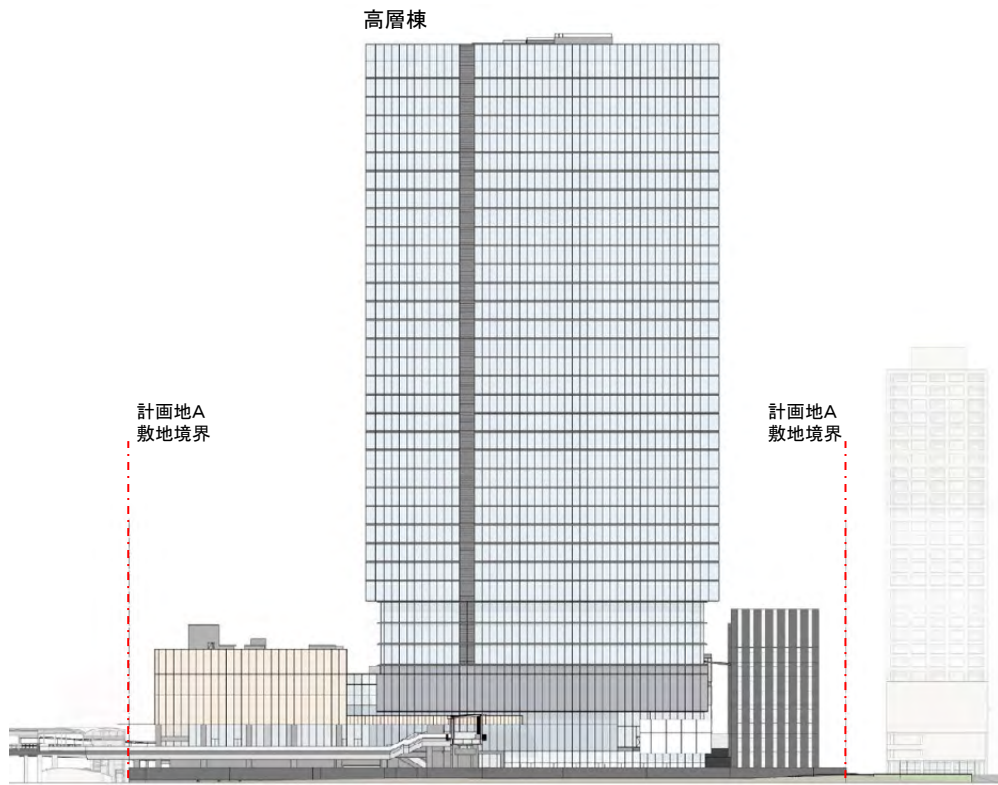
(3) 計画建築物立面図 (北側) (S = 1 : 1,800)
